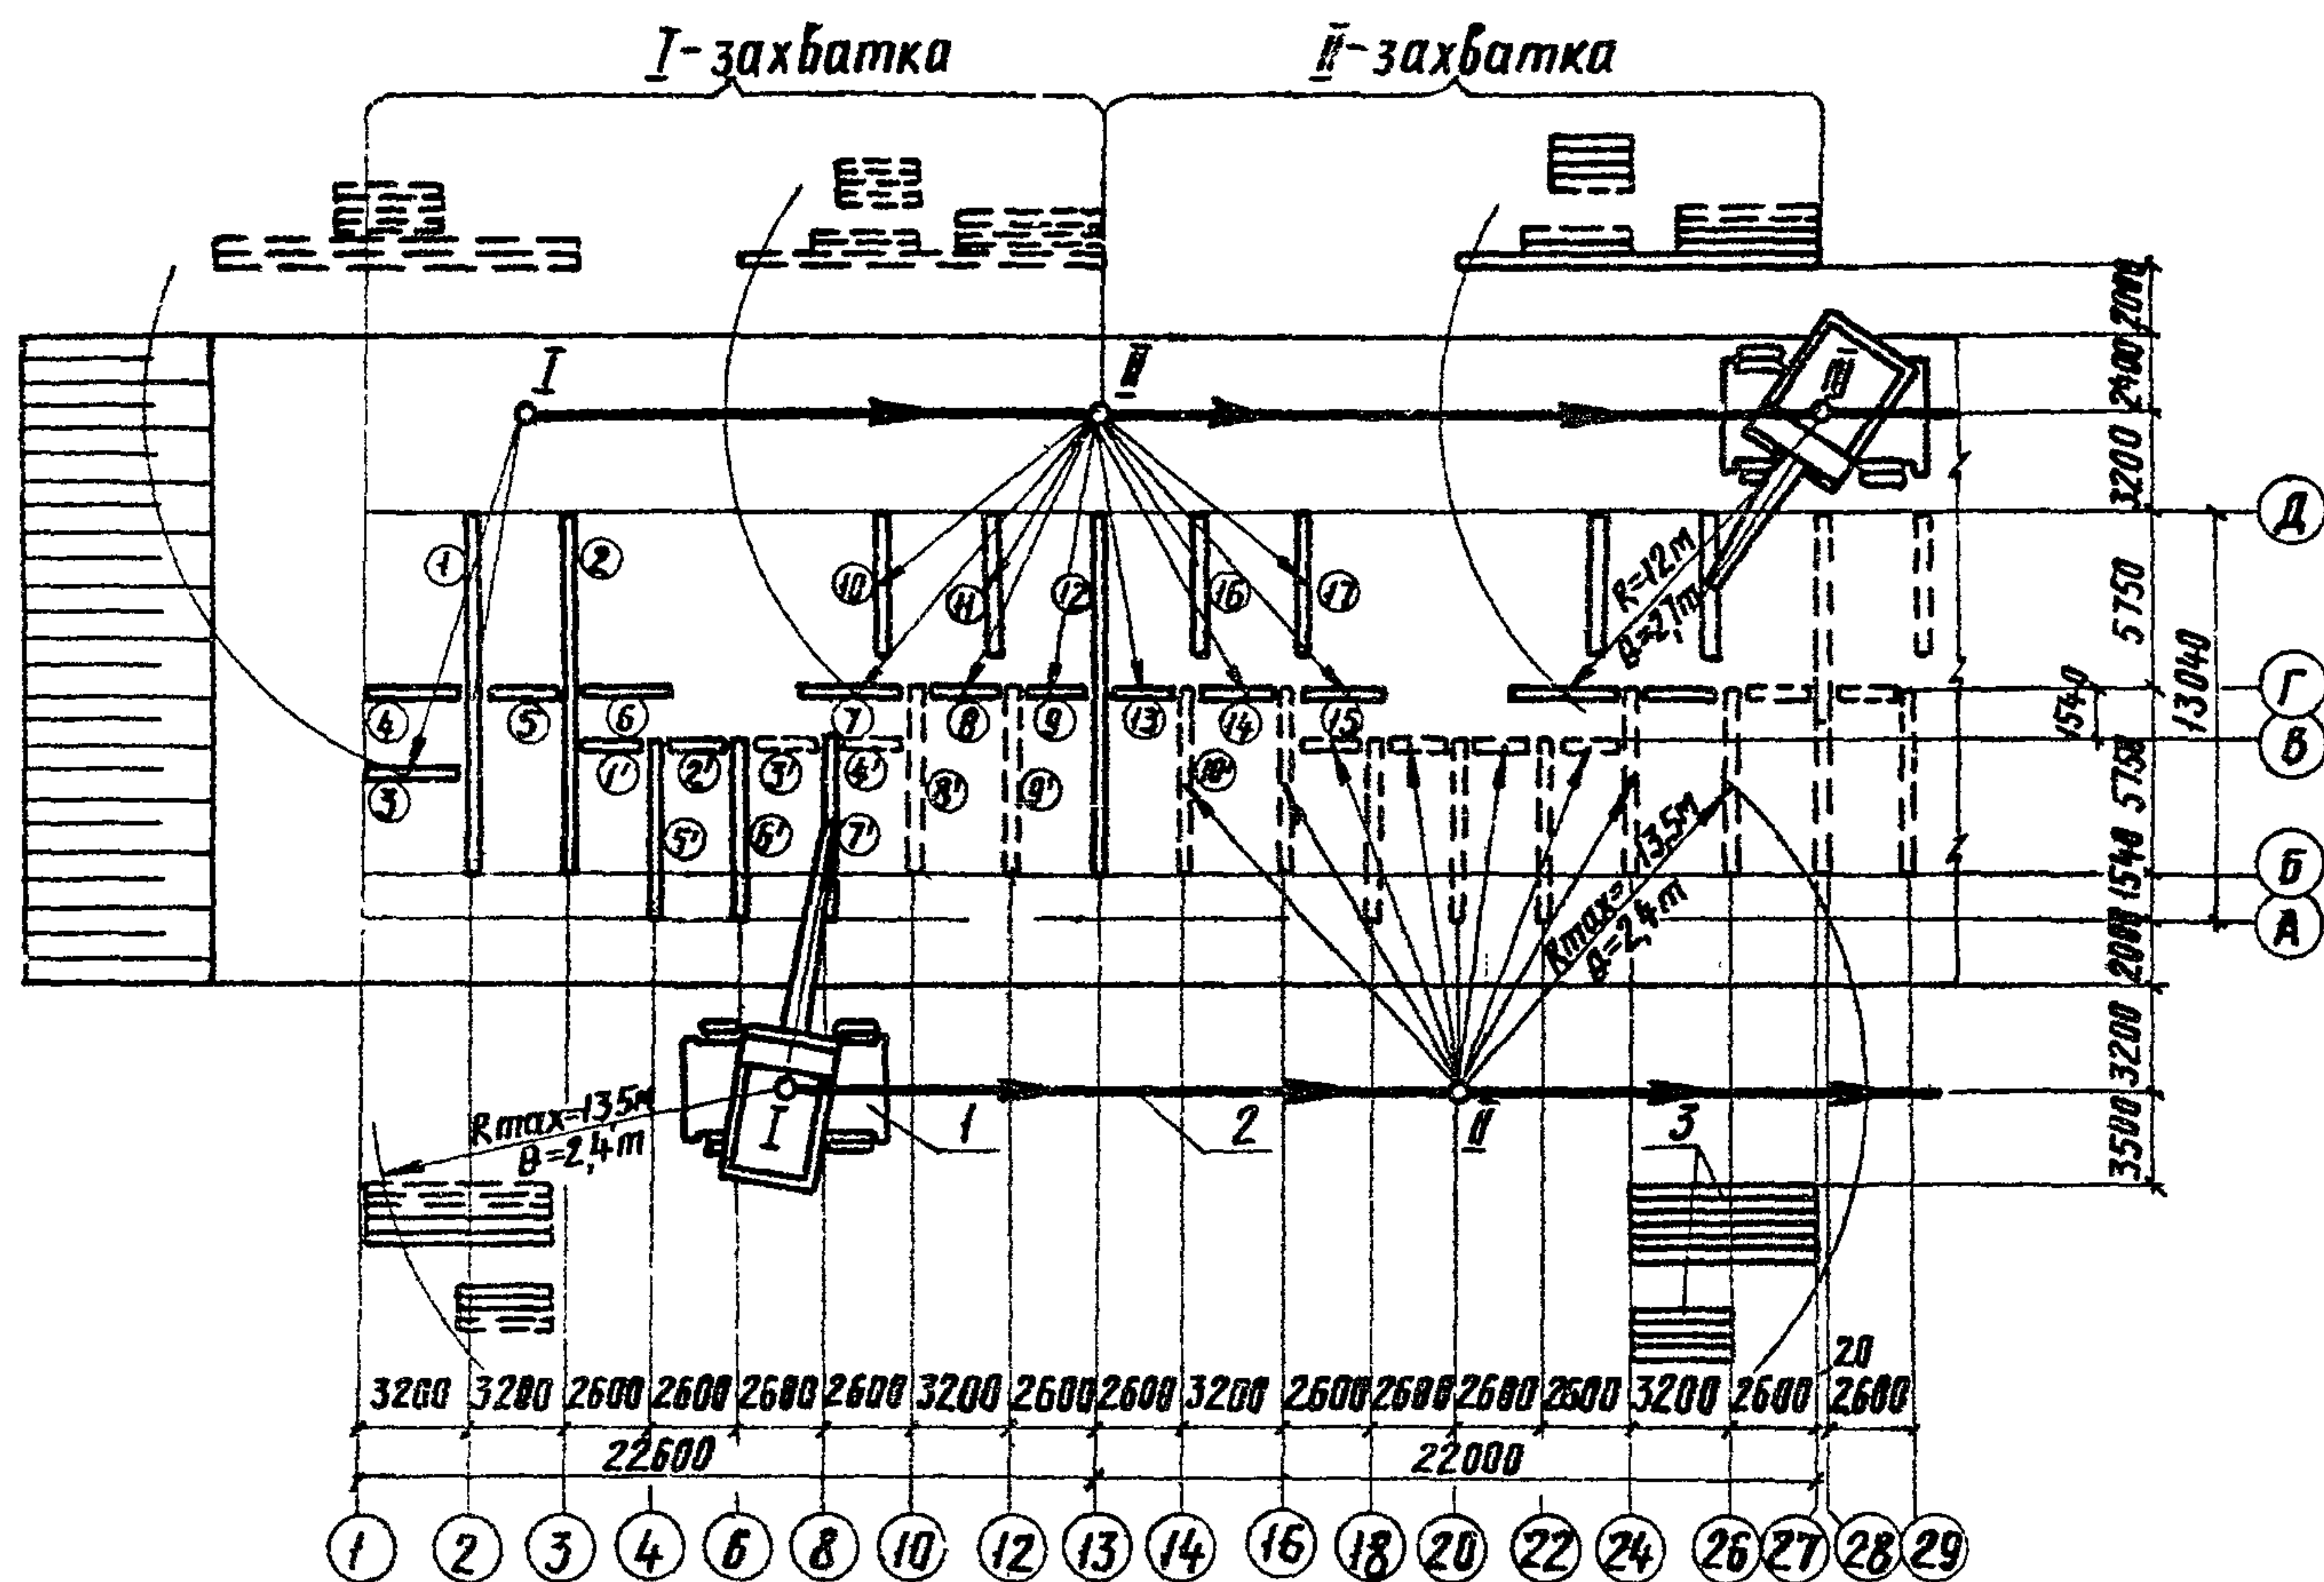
Схема организации работ по монтажу ростверков и балок: I-пневмоколесный край К-16 I; 2-ось движения крана; 3-штабеля ростверков и балок; ① ② ③ и т.д. - последовательность монтажа ростверков и балок краном I; ①' ②' ③' и т.д. - последовательность монтажа ростверков и балок краном II; I, II, III - стоянки крана
